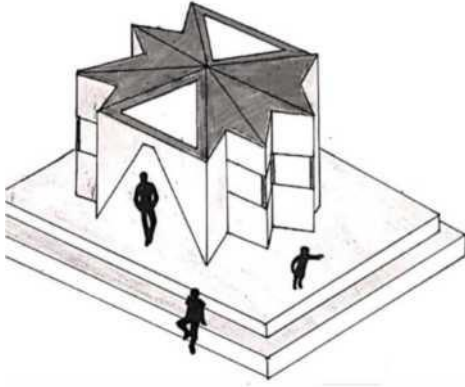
NN3 Temel plan fikir çizimleri, 2020
